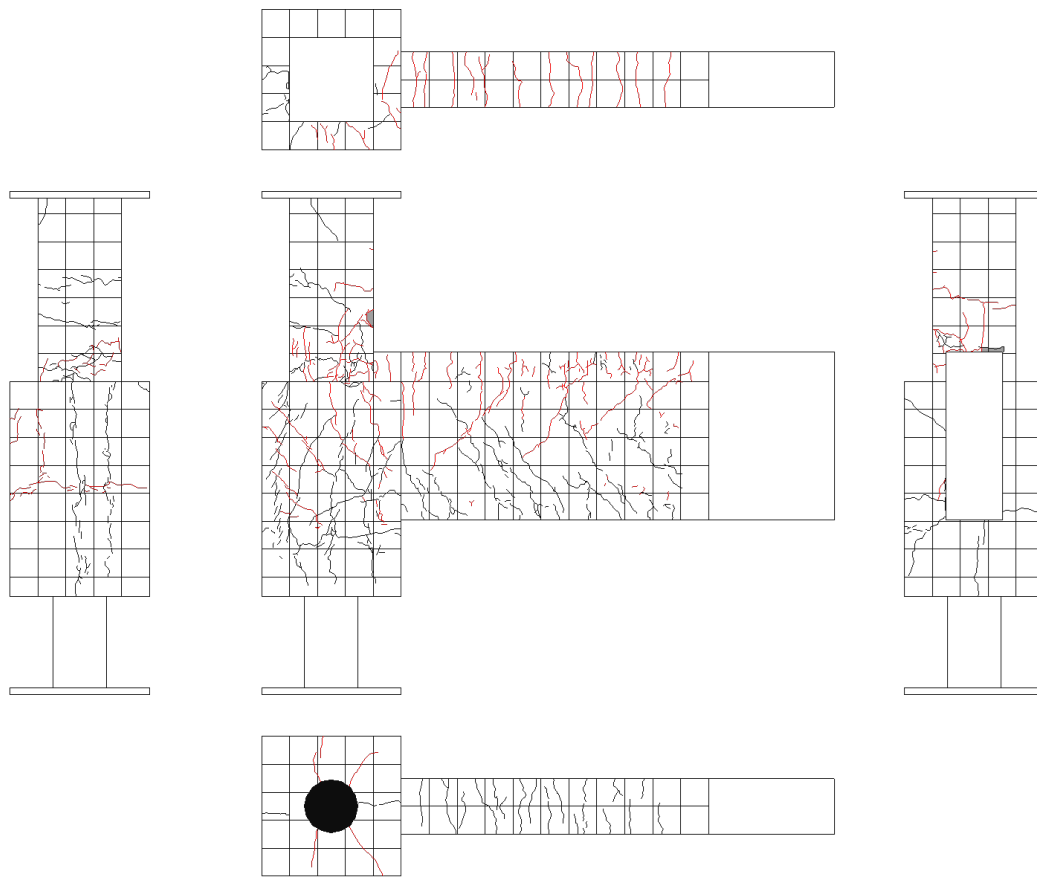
試験体 A-7a ひび割れ状況 (5Cycle)
